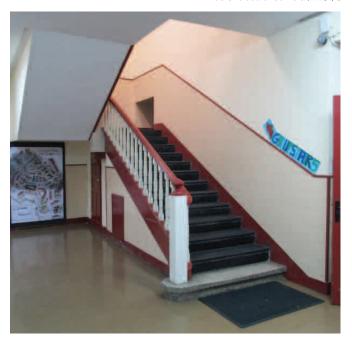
Escaleras entre la planta baja y la planta primera (fuente propia)
